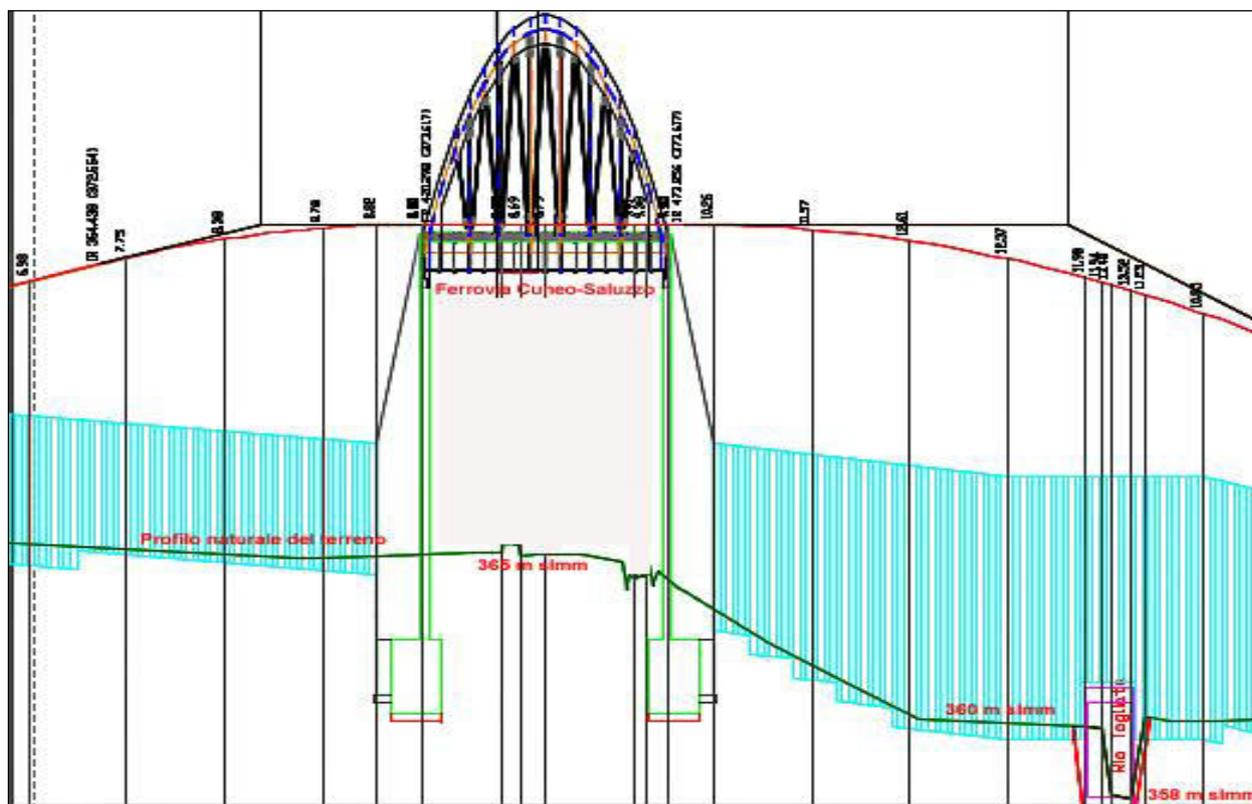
/1 – Stralcio della tavola n. 8 "Profilo longitudinale di progetto – Asse principale"
